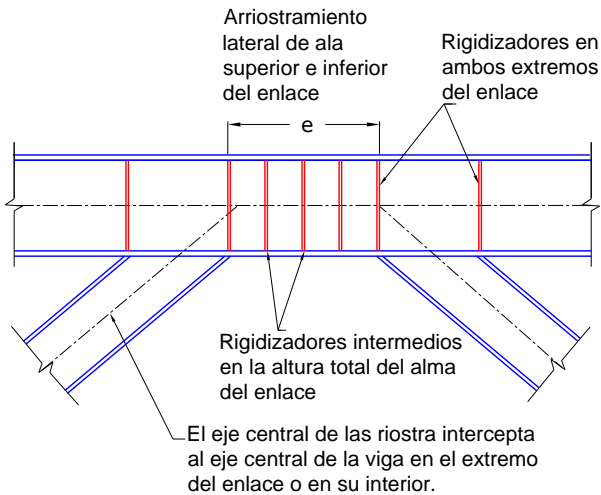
Detalle del enlace en la zona central de la viga con riostras formadas por secciones I.
